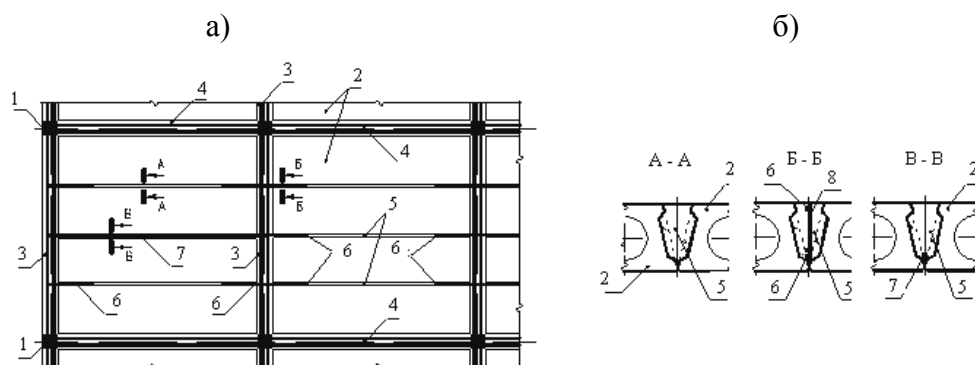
Фрагмент плана диска перекрытия (а) и сечения межплитных швов (б)
